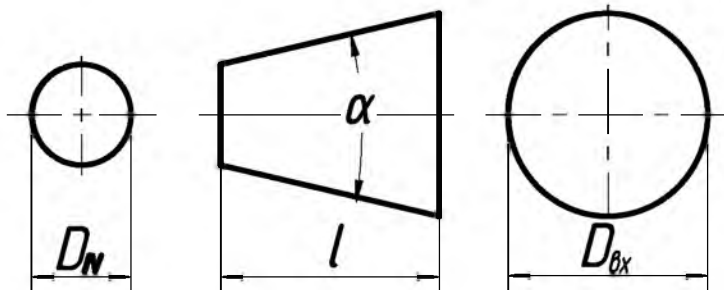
Эскиз перехода к вентилятору ВР120-45-8
